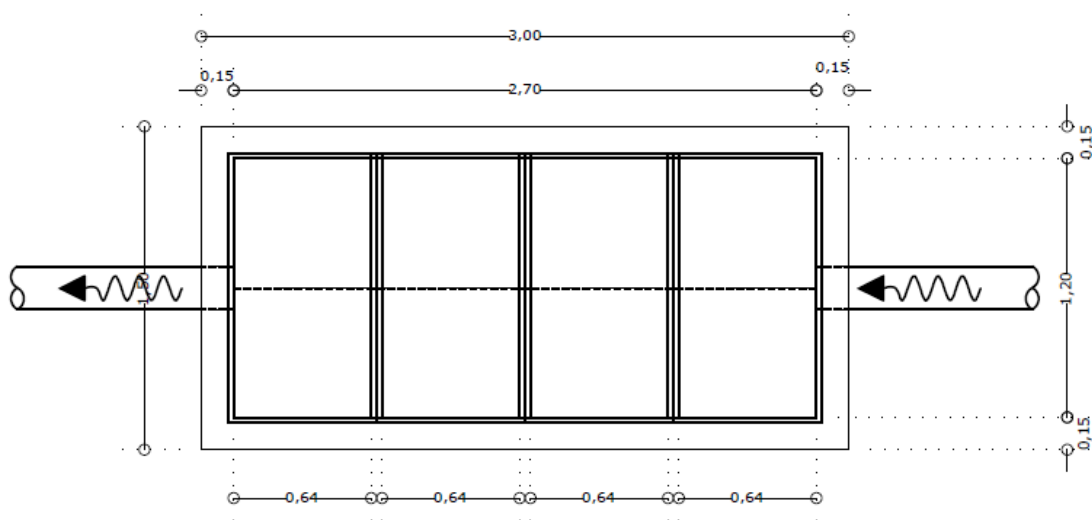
Dimensiones Cámara Desengrasadora. Vista en planta.
